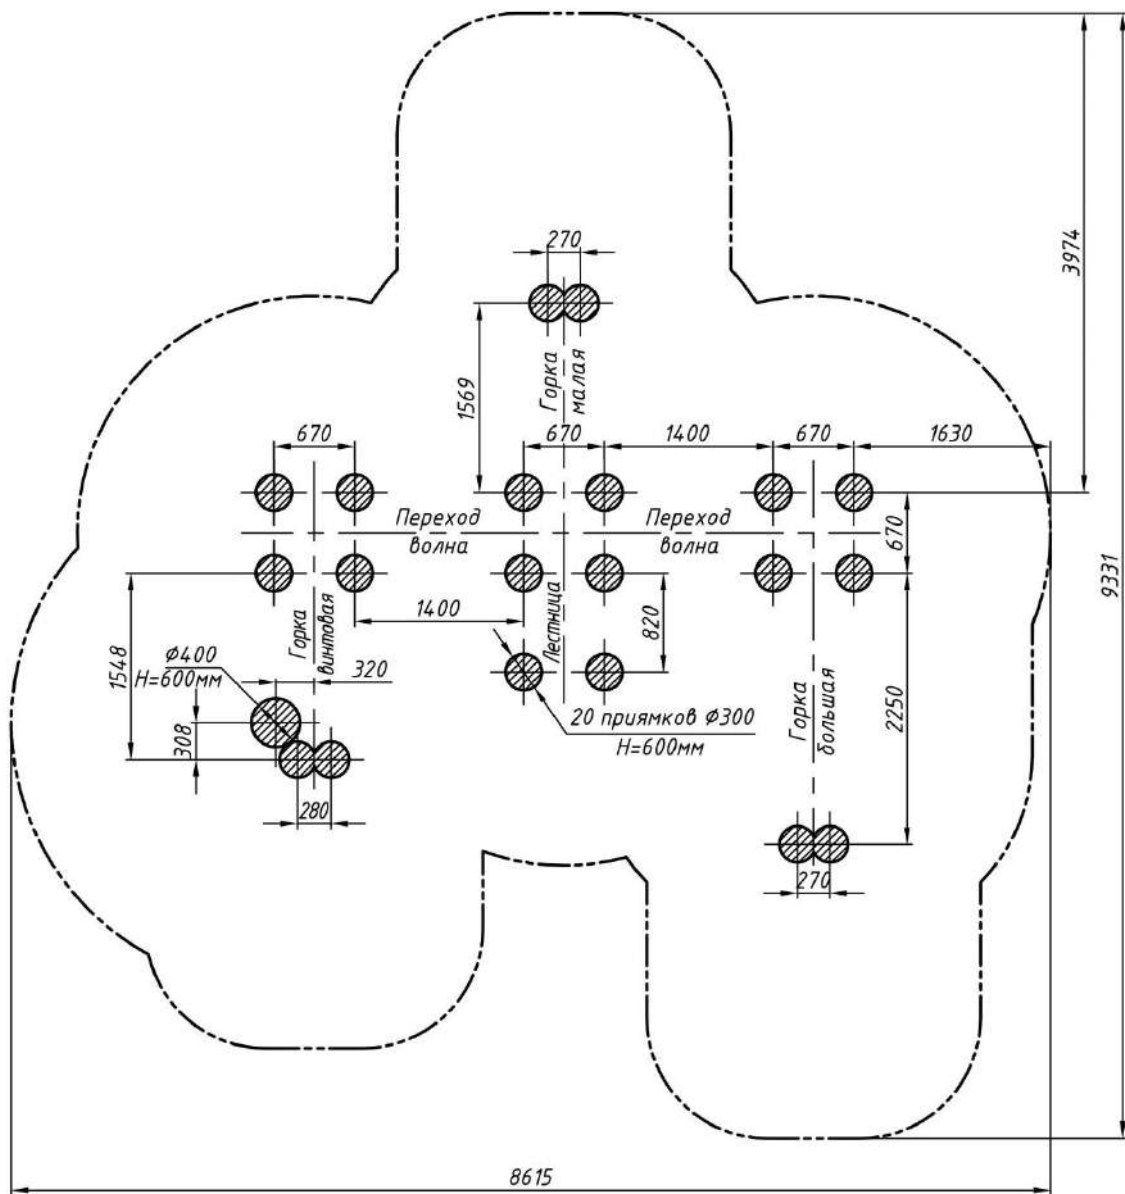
План фундамента игрового комплекса РТР 21-08-Т1
